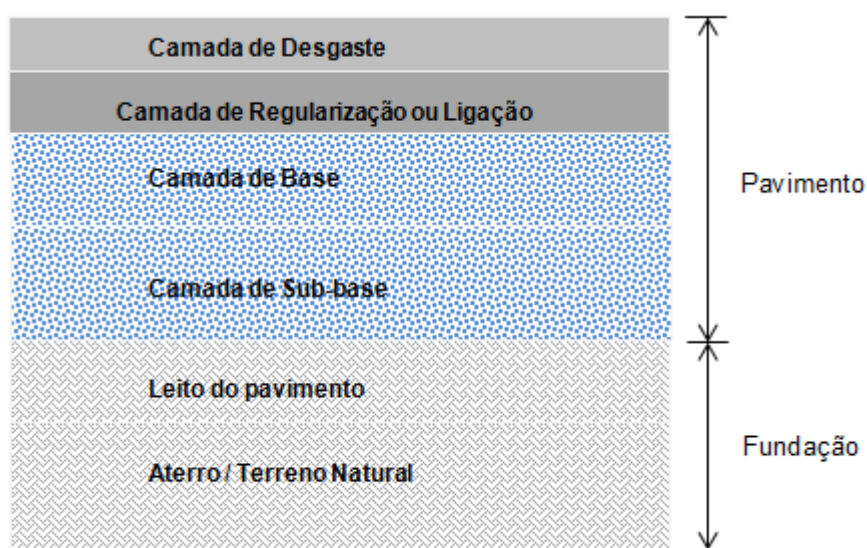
Constituição de uma estrutura tipo de um pavimento rodoviário
